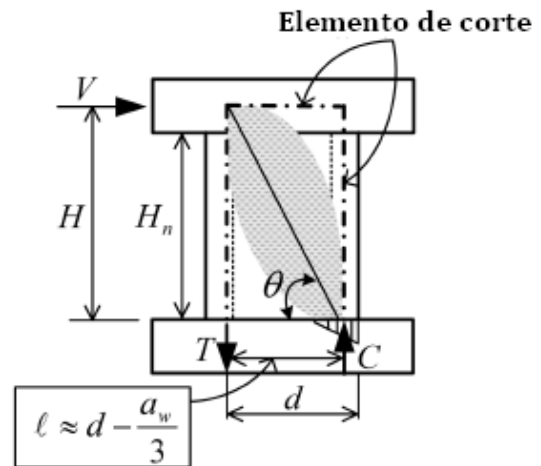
“Elemento de Corte para Muro en Voladizo” (Bali y Hwang (2007)).
